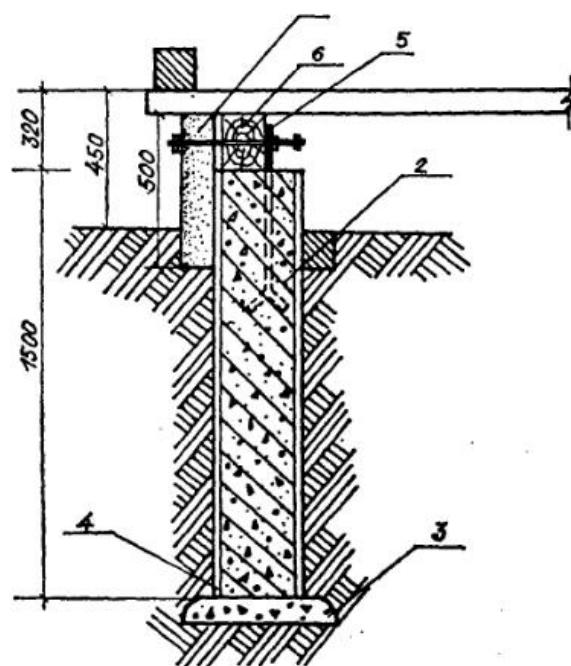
Буровые сваи для щитовых домиков: 1 — забирка; 2 — бетонный раствор; 3 — бетонная подушка; 4 — асбестоцементная труба; 5 — анкер; 6 — деревянный брус нижней обвязки.
